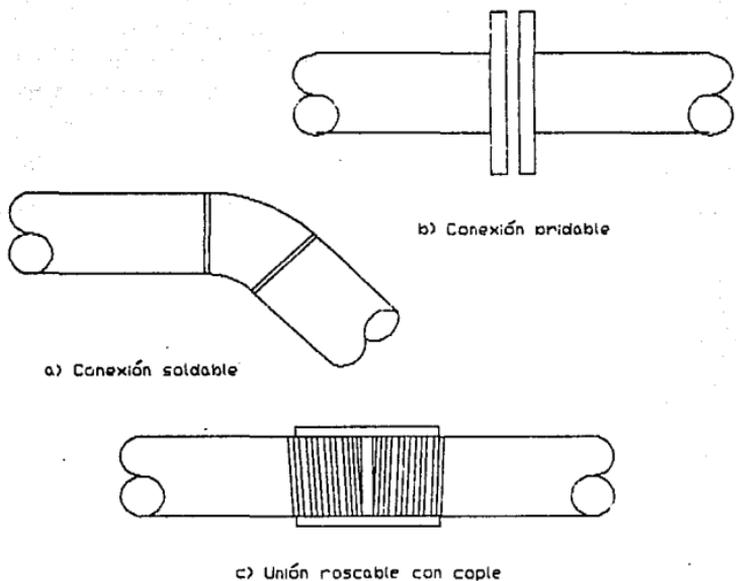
Las juntas o uniones en las tuberías pueden ser soldables, bridables o roscables. Todas estas deberán ser a prueba de líquidos. Las juntas en los sistemas de tuberías que manejen líquidos Clase I deberán ser soldables cuando sean localizadas en espacios cerrados dentro de edificios, debido a su peligrosidad. Las conexiones soldables o bridables son preferidas para tuberías superficiales. Las conexiones roscables de tubería mayor de 3" (76.2 mm) de diámetro, son susceptibles a desconectarse en una larga exposición a incendio; a menos que, las conexiones sean soldadas por detrás. En general, son recomendables las conexiones bridables o soldables para tubería mayor de 2 1/2" (63.5 mm) de diámetro.
